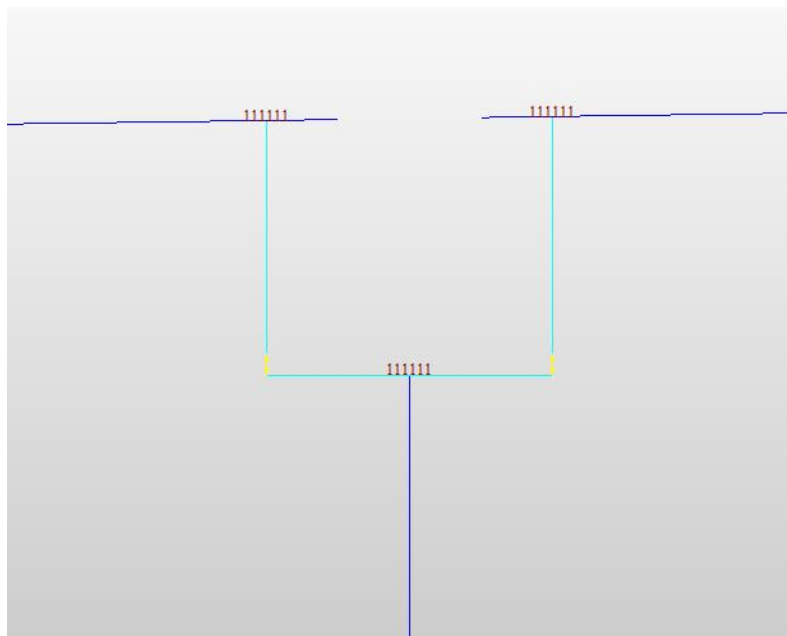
Modellazione del collegamento tra impalcato e sottostrutture
